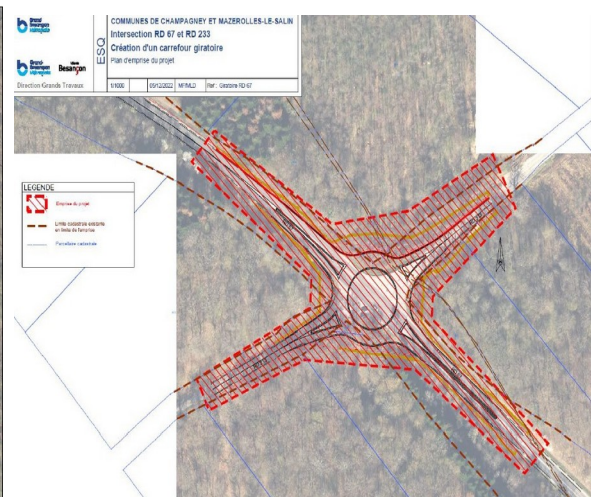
Plan général du giratoire de la RD 67 (source dossier)
